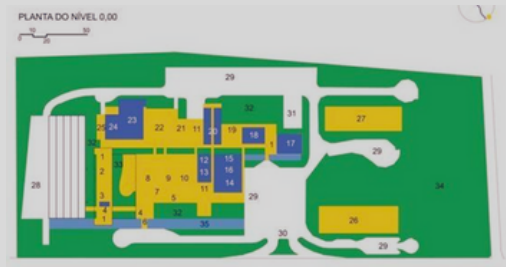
Planta de setorização. Fonte: (PERÉN, 2007)
